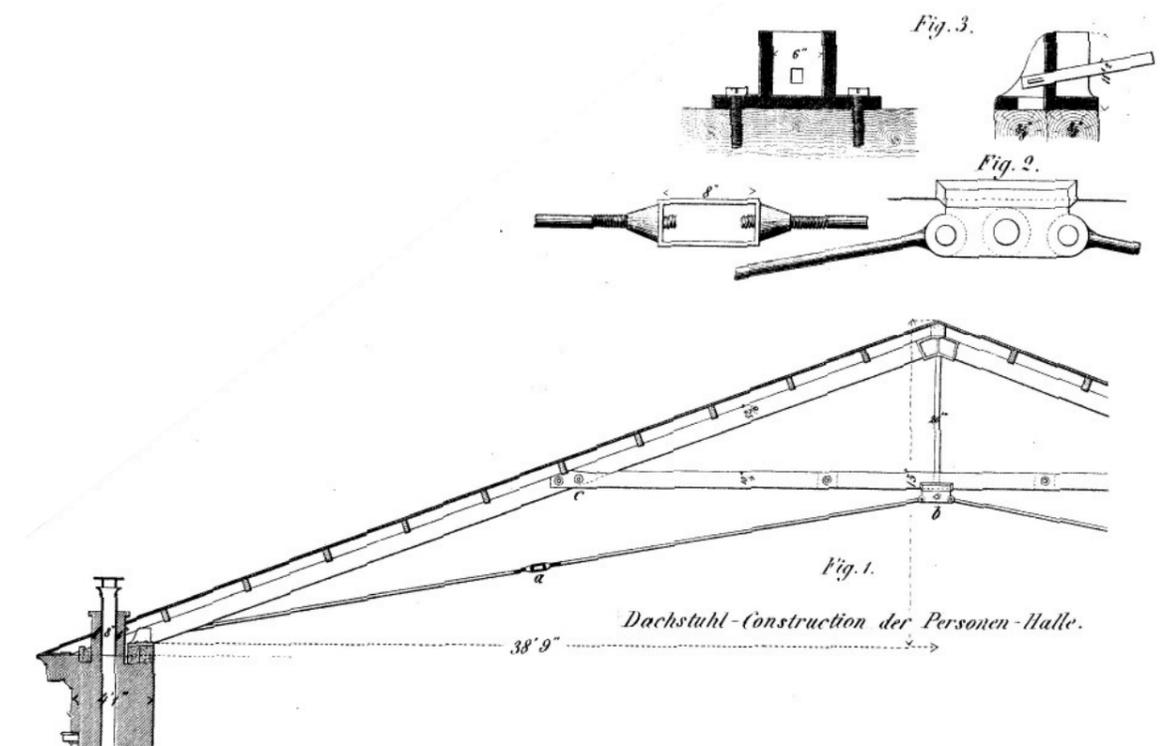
Detailplan Dachstuhlkonstruktion, Schnittzeichnung, 1842
